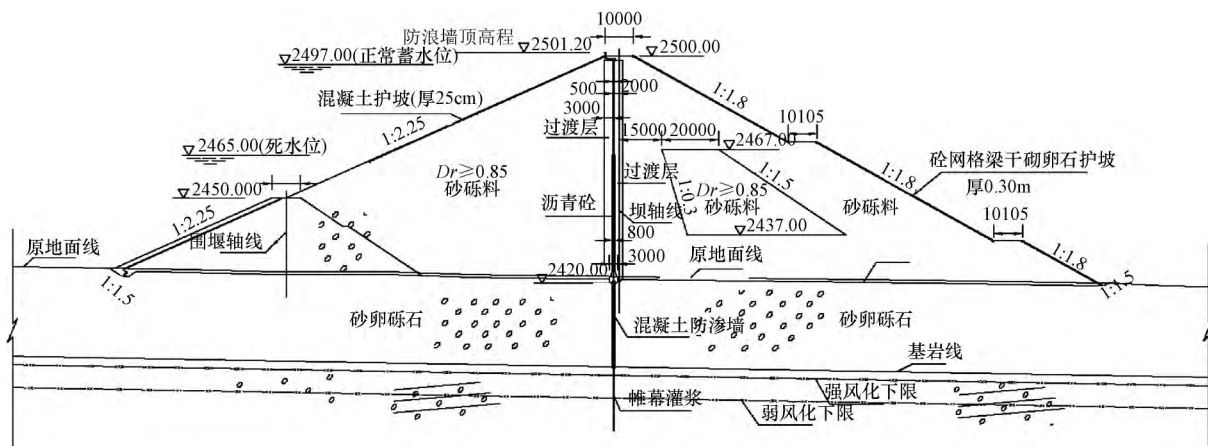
土石坝最大断面示意(高程单位: m; 尺寸单位: mm)
